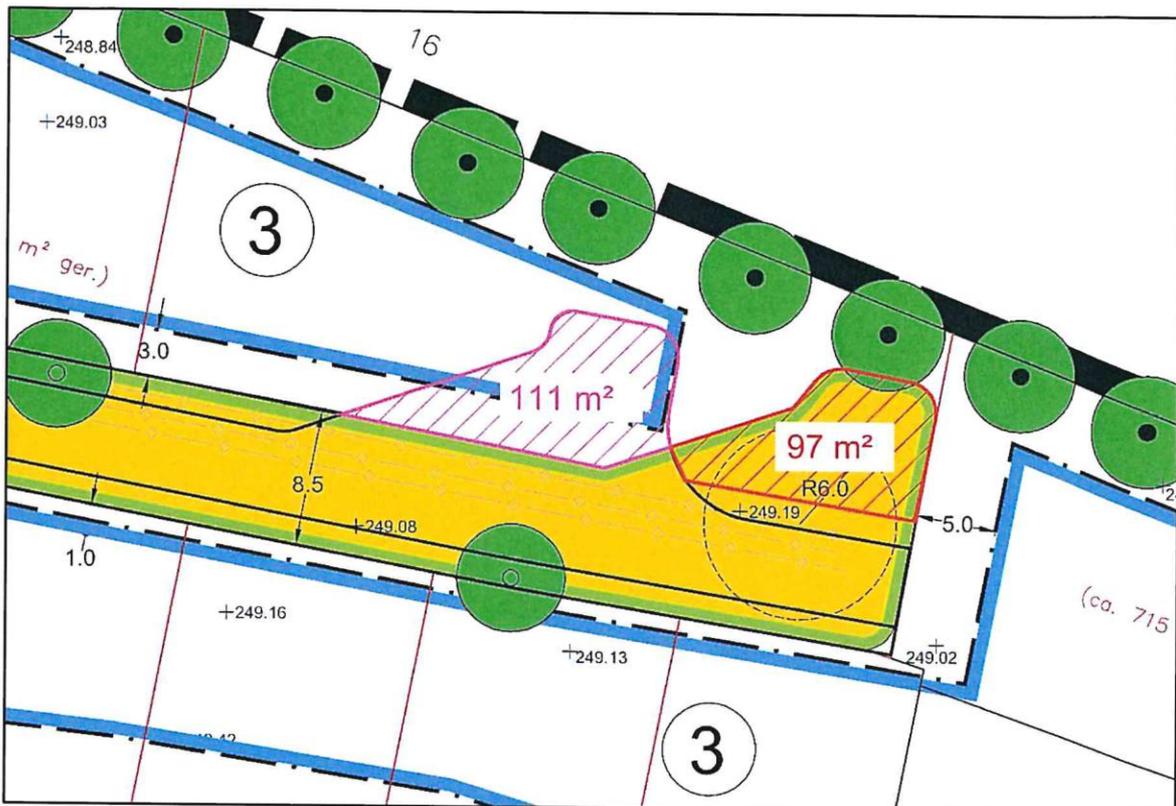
Überlagerung Straßenplanung / Bebauungsplan
